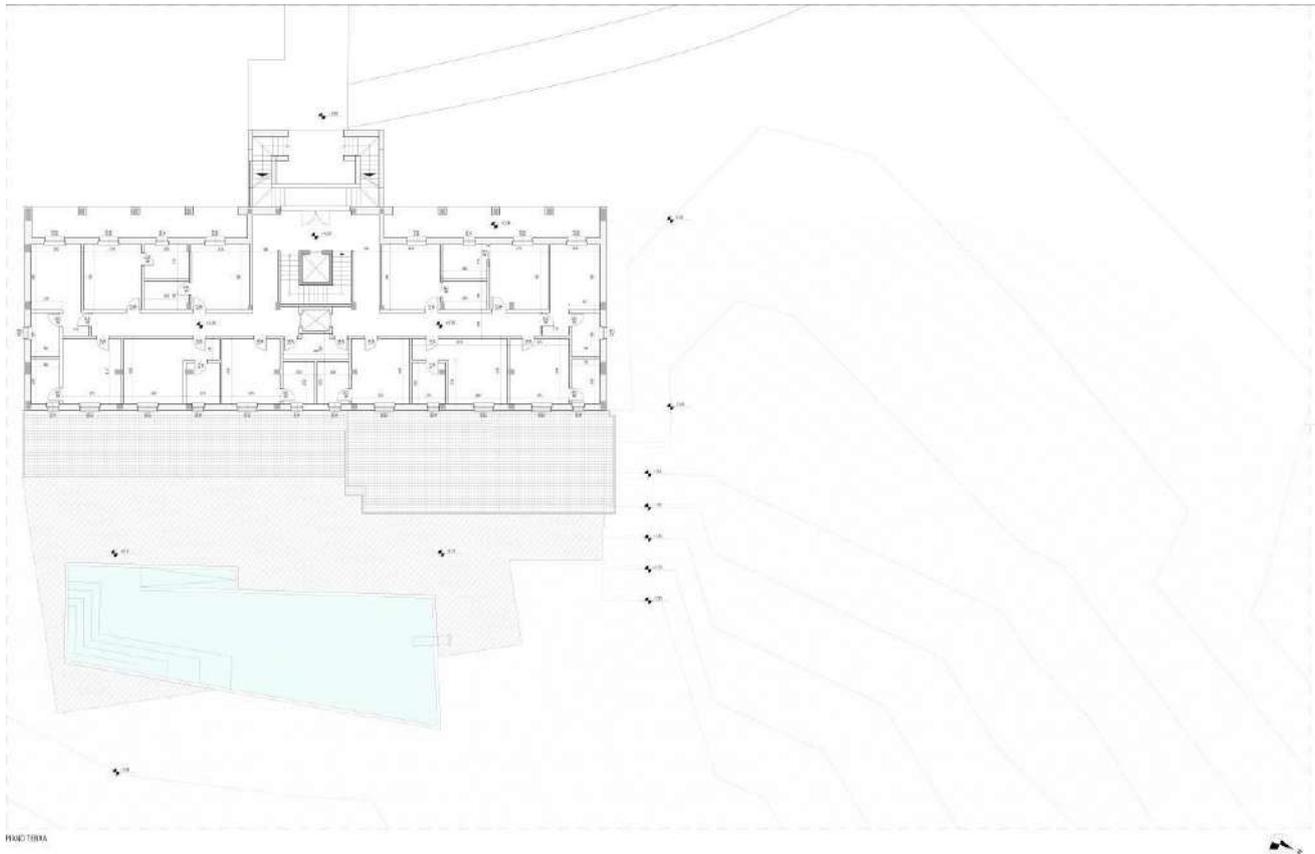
Stato di fatto del Piano Terra – Tav. PA08
